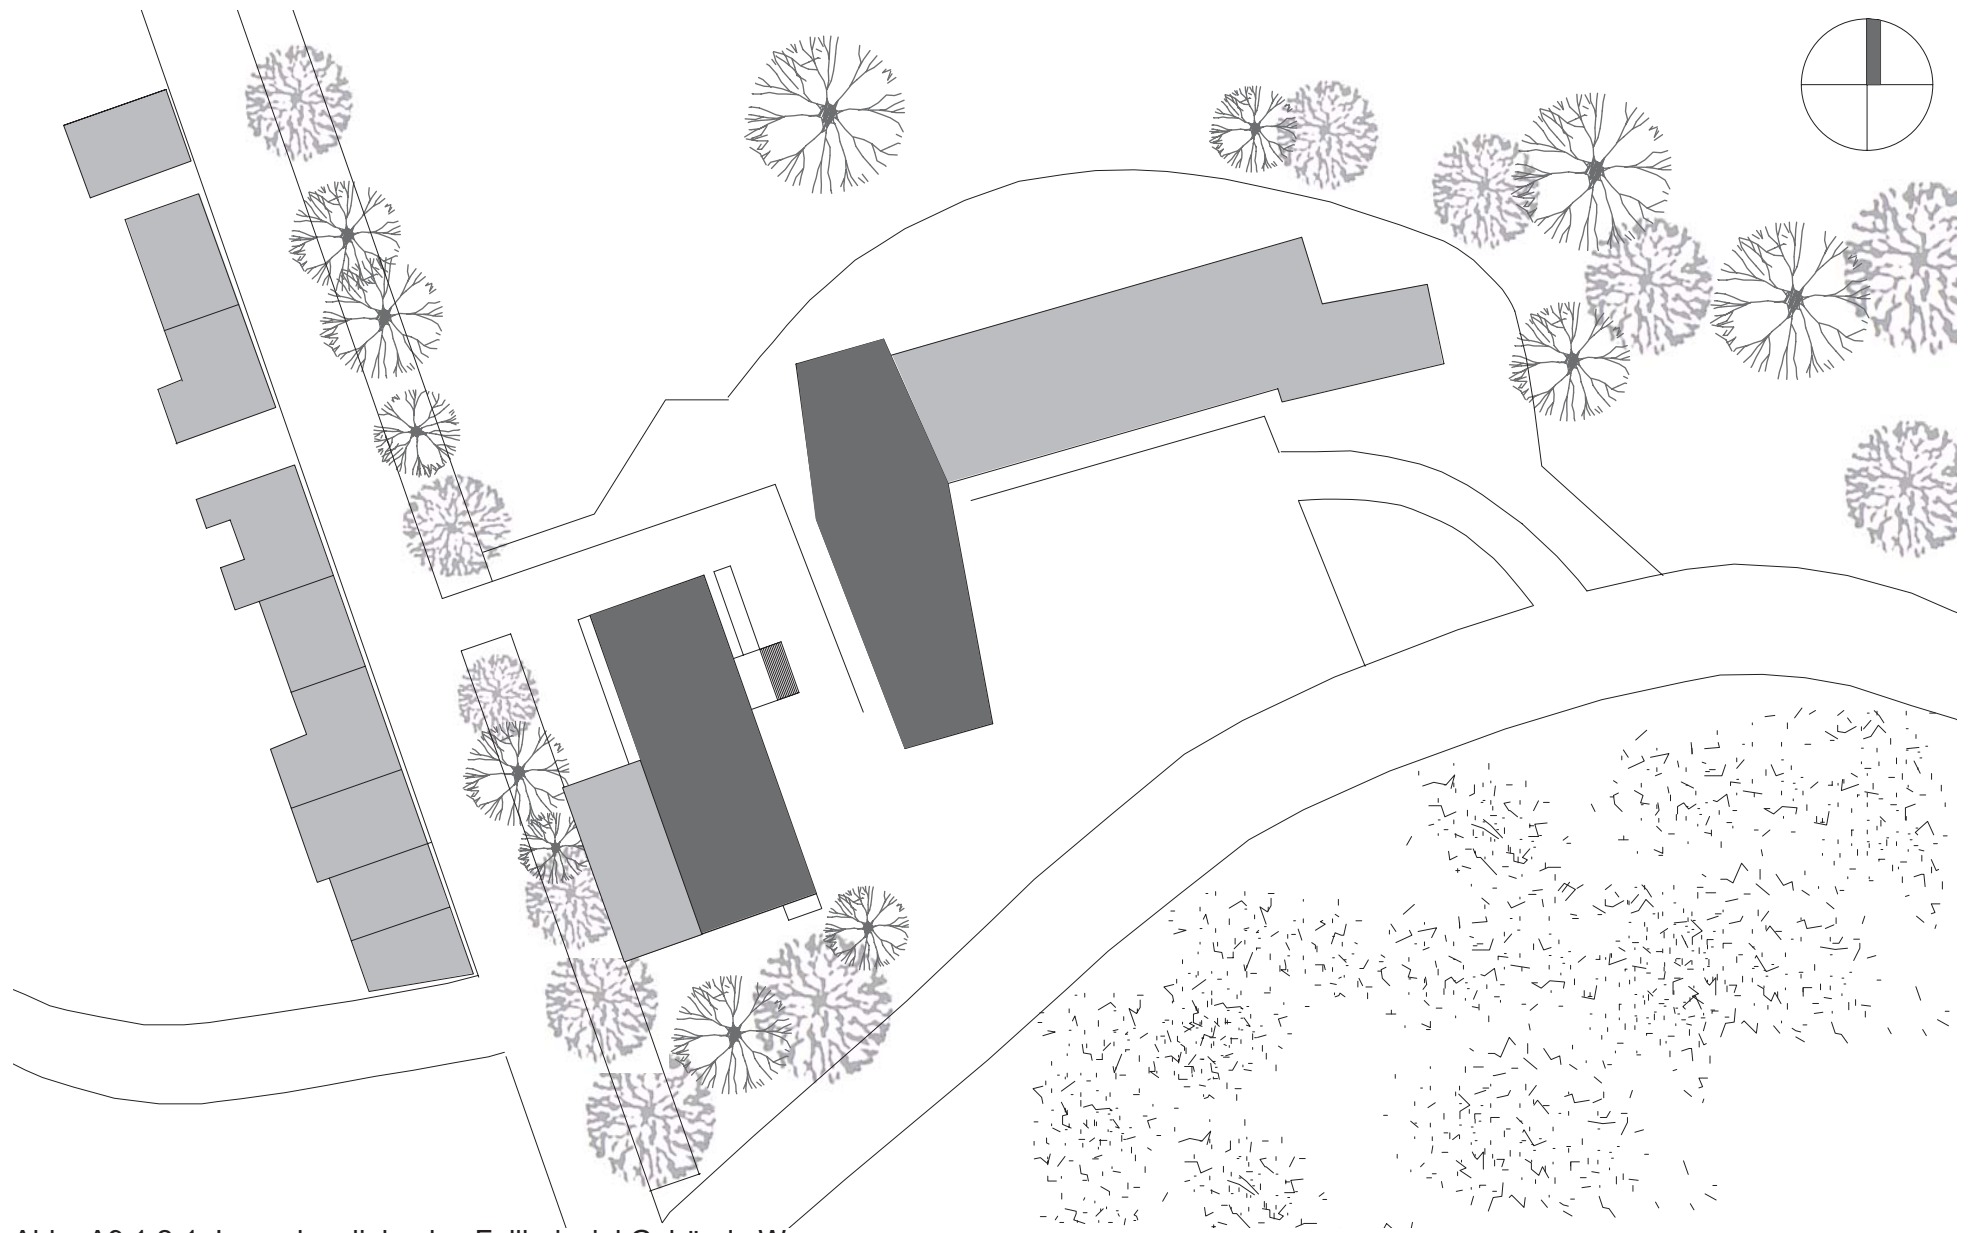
Lageplan, links das Fallbeispiel Gebäude W
